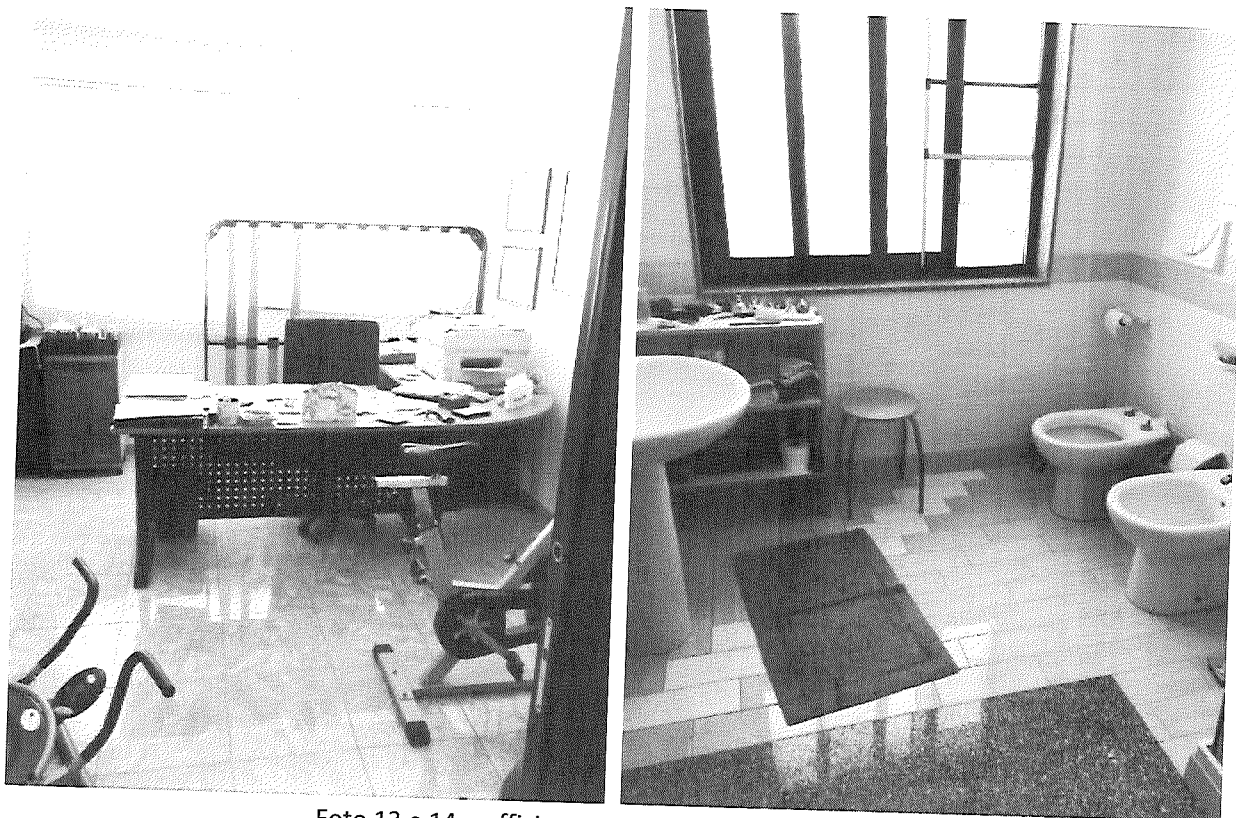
e 14 – ufficio e servizi igienici a piano primo
